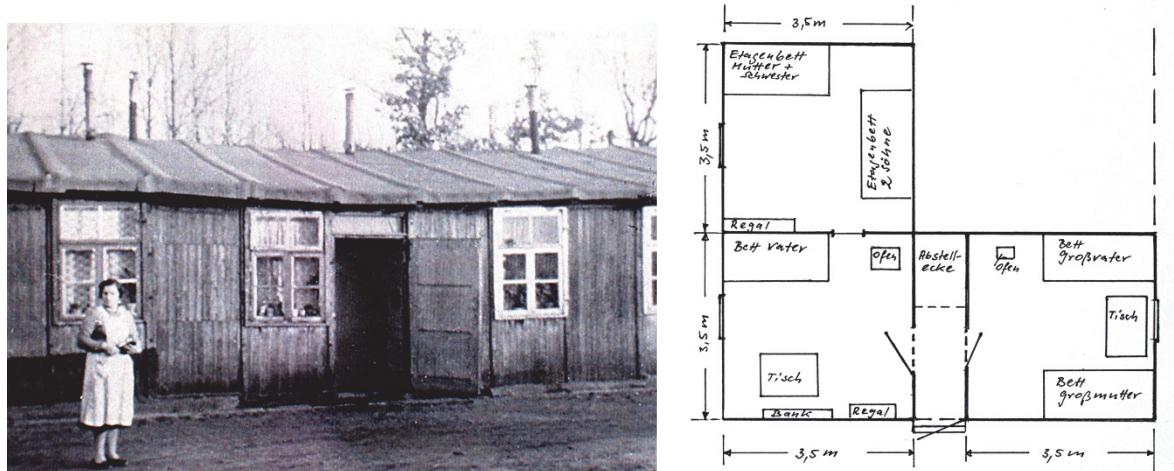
Grundriss der Baracken-„Wohnung“ für eine 7-köpfige Familie
